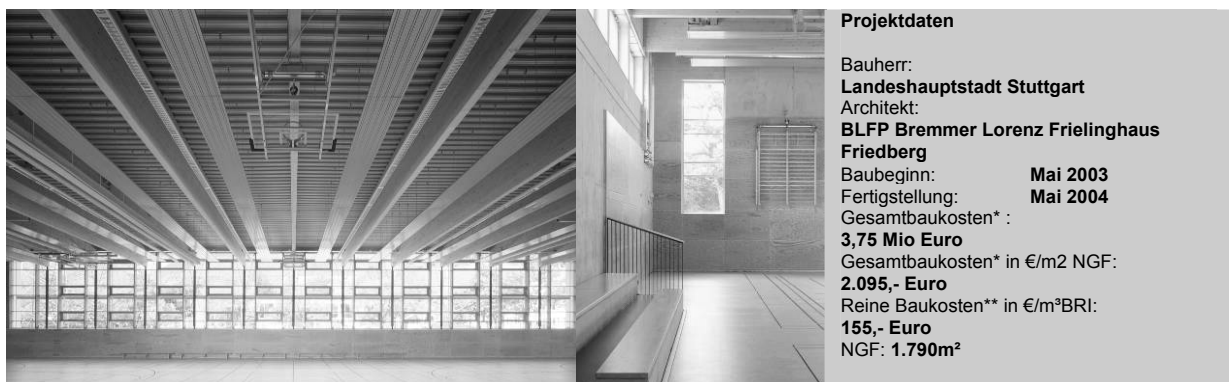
Ballspielhalle, Stuttgart-Obertürkheim
